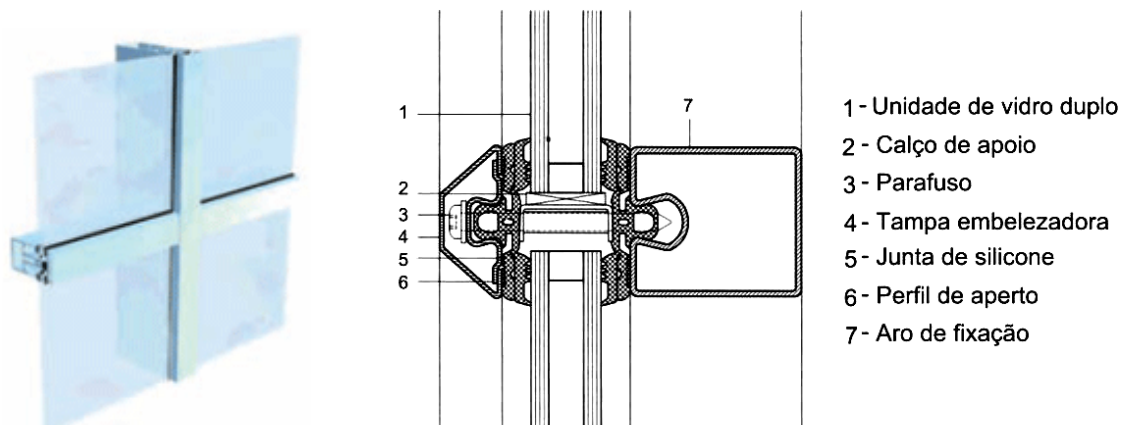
Sistema de fixação contínuo – fachada cortina [8 e 13].
